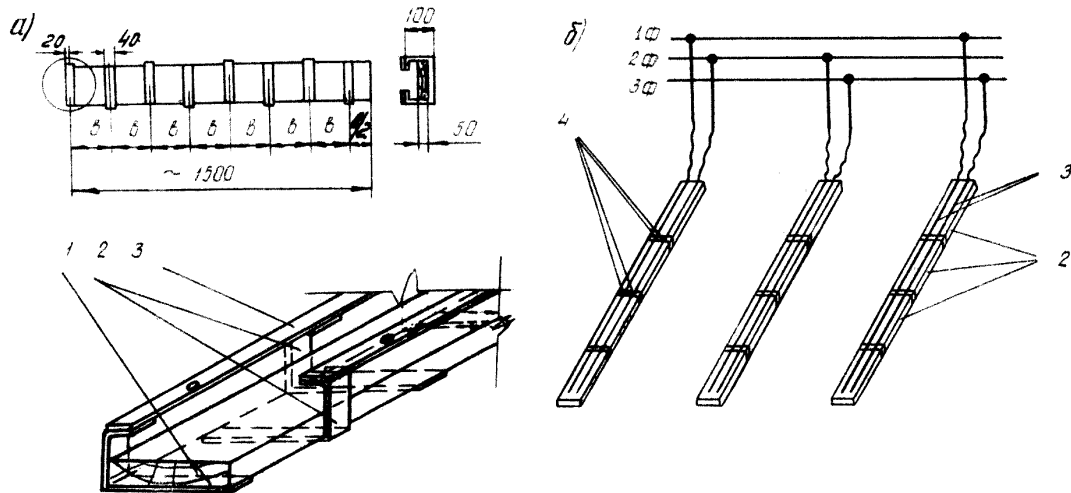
Рис. II. Накладной щит с полосовыми электродами (а) и схема коммутации электродов (б) при электропрогреве стыков между плоскими плитами покрытия:
